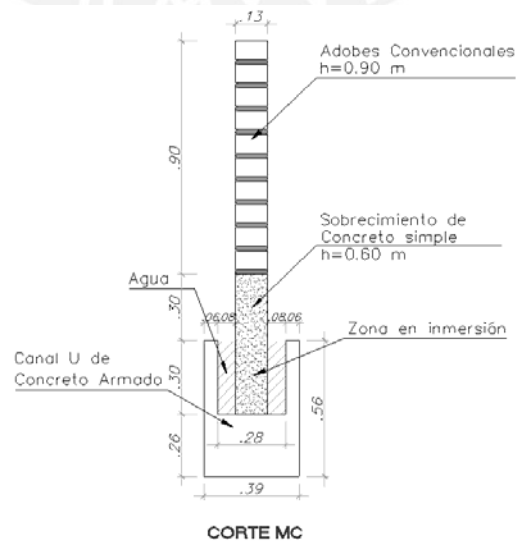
Sección transversal Muro con Sobrecimiento MC.
